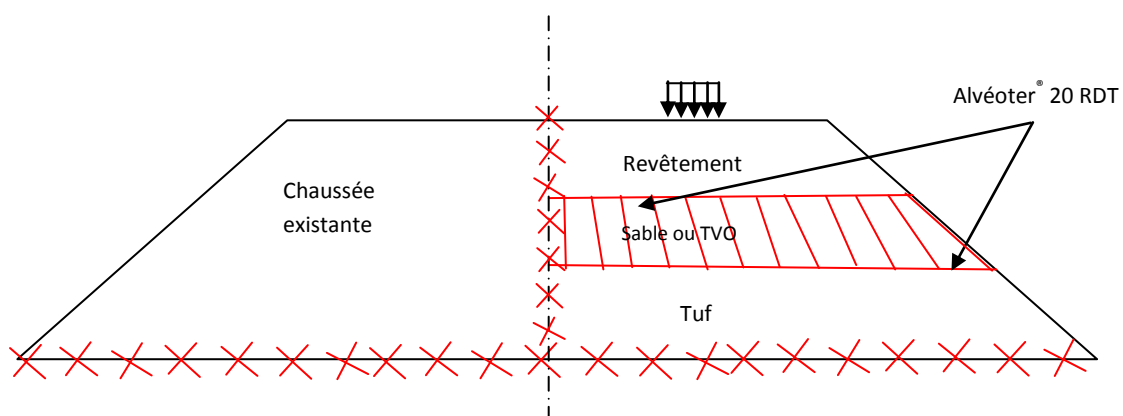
VUE DE FACE DE LA PLANCHE D'ESSAI EN SOLS RENFORCÉS
